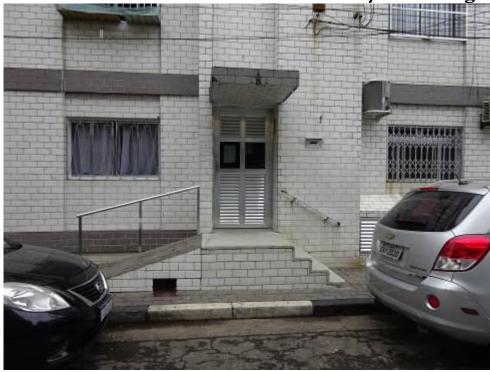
Vista de janelas do imóvel avaliando na fachada frontal.
